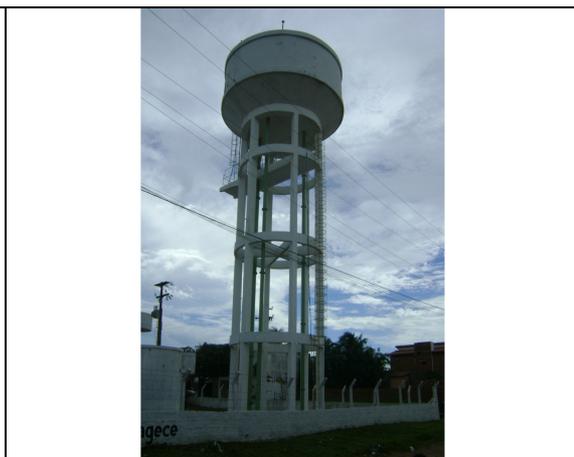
REL-01: laje de cobertura sem guarda-corpo.
